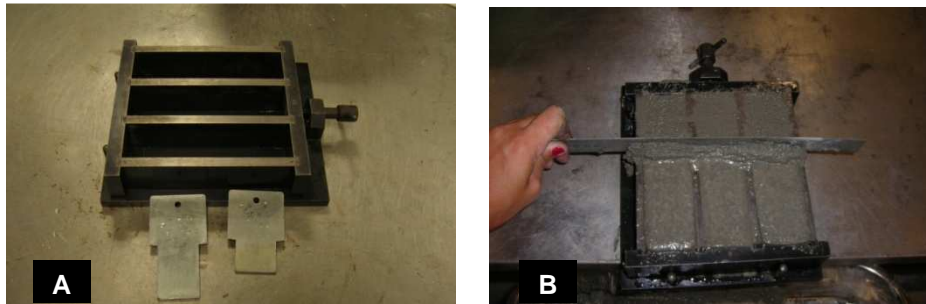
Molde (A) e moldagem (B) dos provetes.
